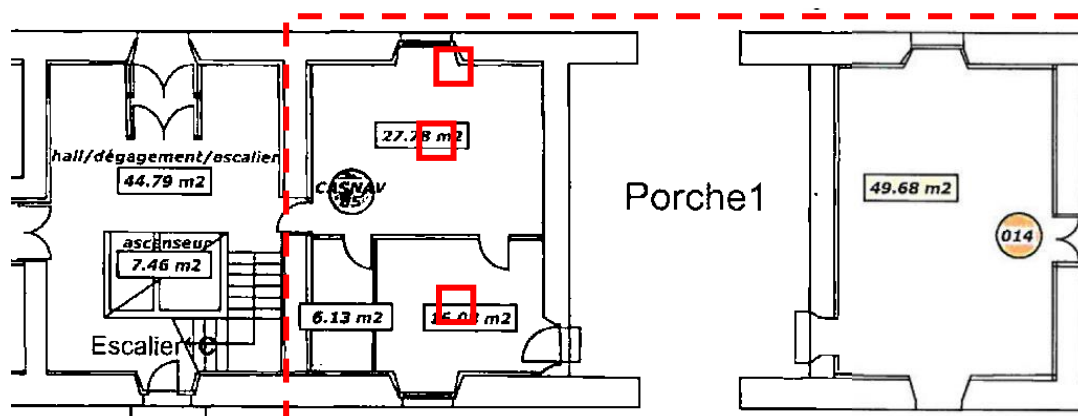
Vue en plan - Niveau Rez-de-chaussée
